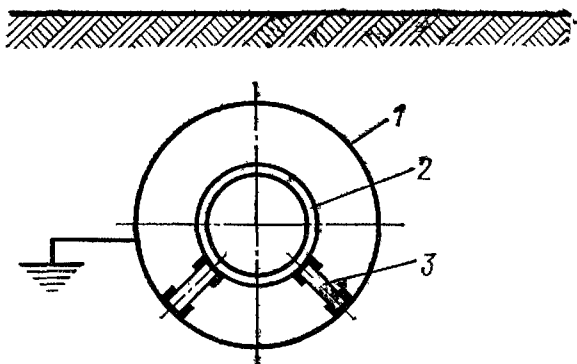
Схема размещения трубопровода в металлическом футляре: 1 — футляр; 2 — трубопровод; 3 — диэлектрическая опора
